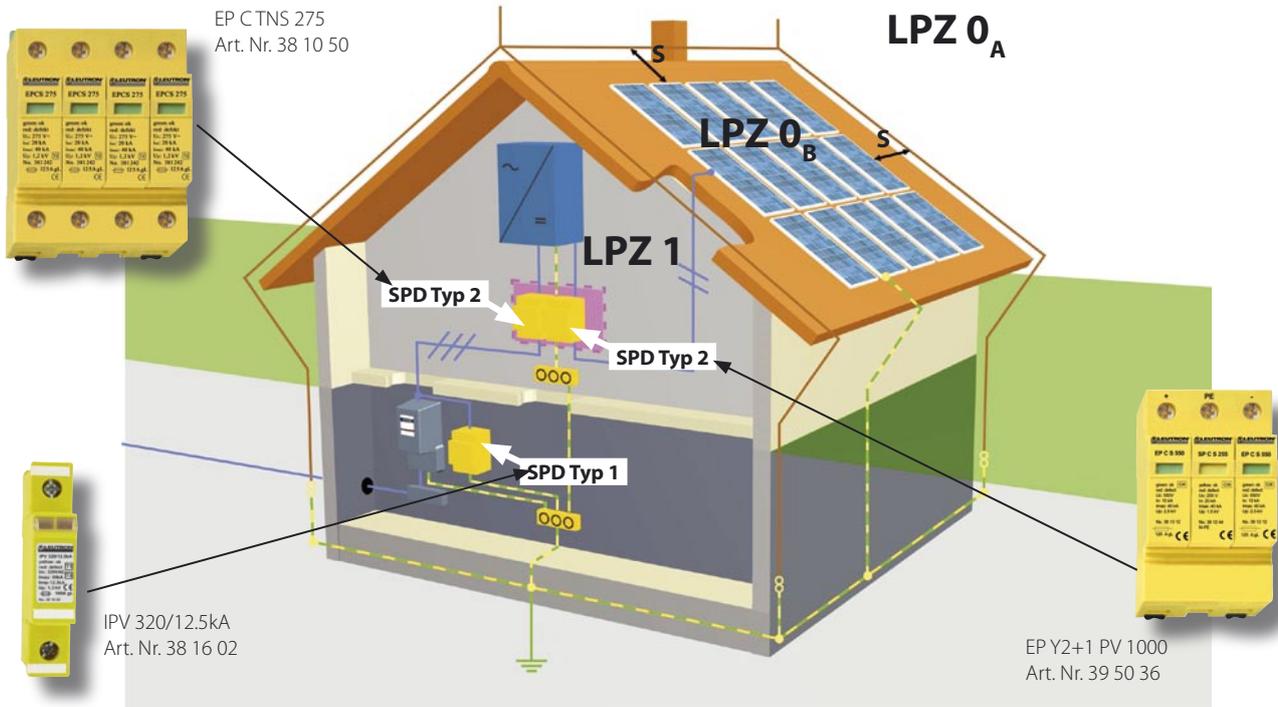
Gebäudeinstallation mit äußerer Blitzschutzanlage und Einhaltung des Trennungsabstands
